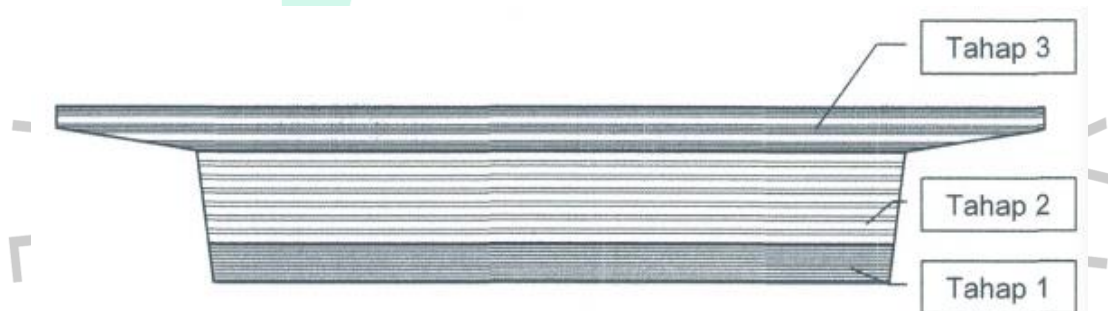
32 Layout Box Girder Ramp 1 (C2)
